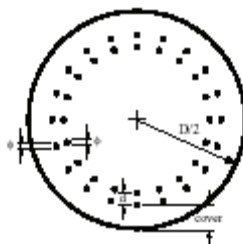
Generica sezione trasversale in calcestruzzo armata con barre in VTR
